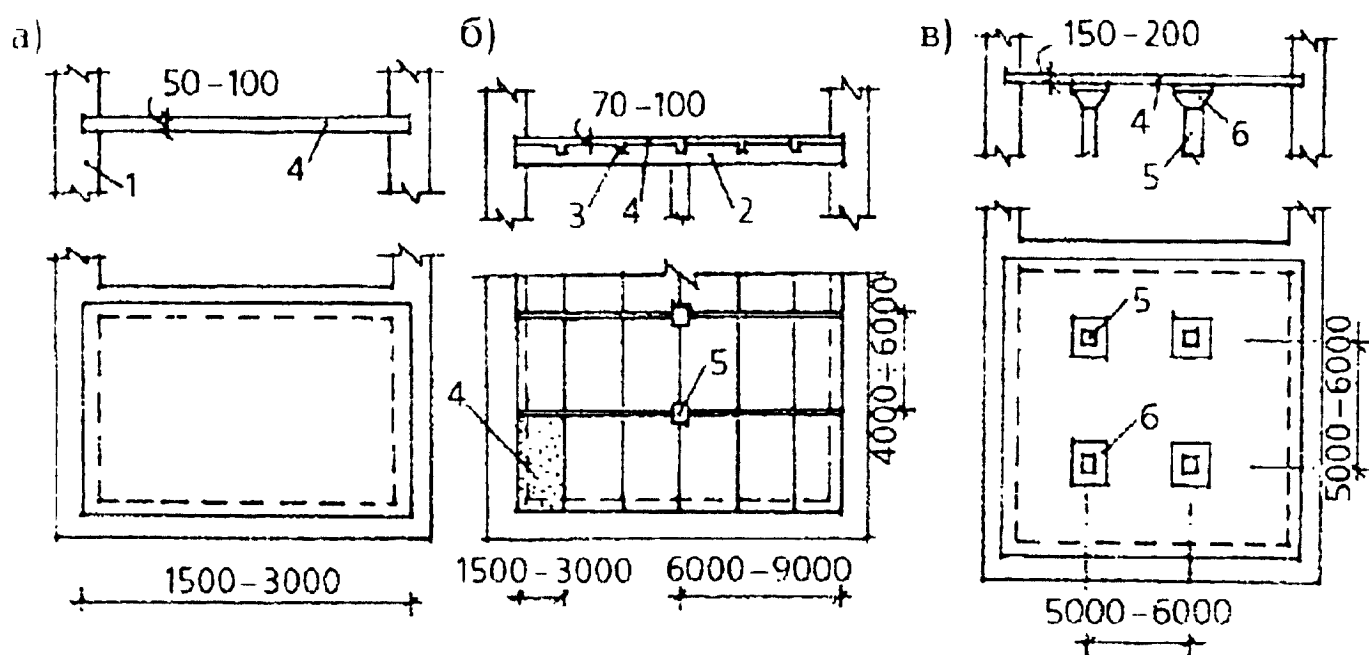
Монолитные перекрытия: а - в виде гладкой плиты; б - балочное; в - безбалочное; 1 - стена; 2 - главная балка; 3 - второстепенная балка; 4 - плита; 5 - колонна; 6 - капитель
